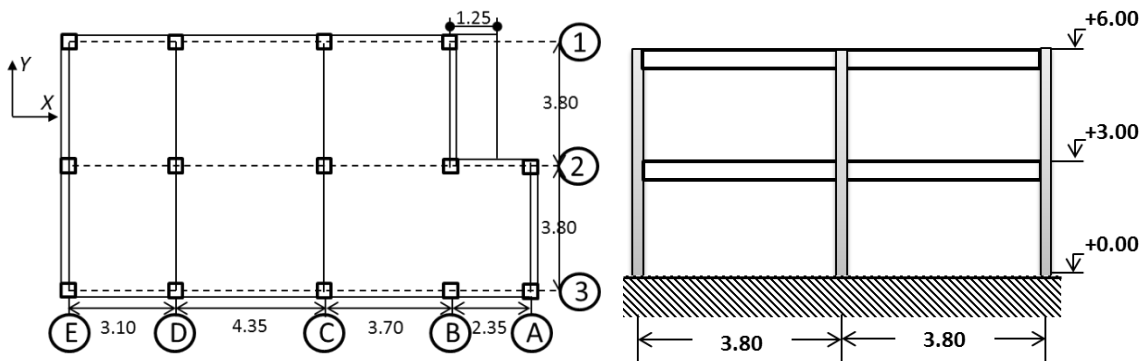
Planta y alzado de edificio de dos niveles (dimensiones en m)
